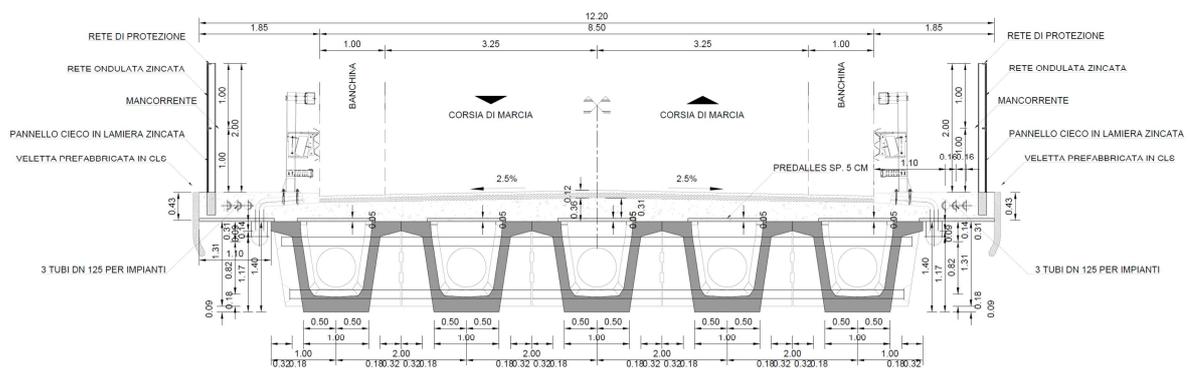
Sezione tipo impalcato cavalcaferrovia
